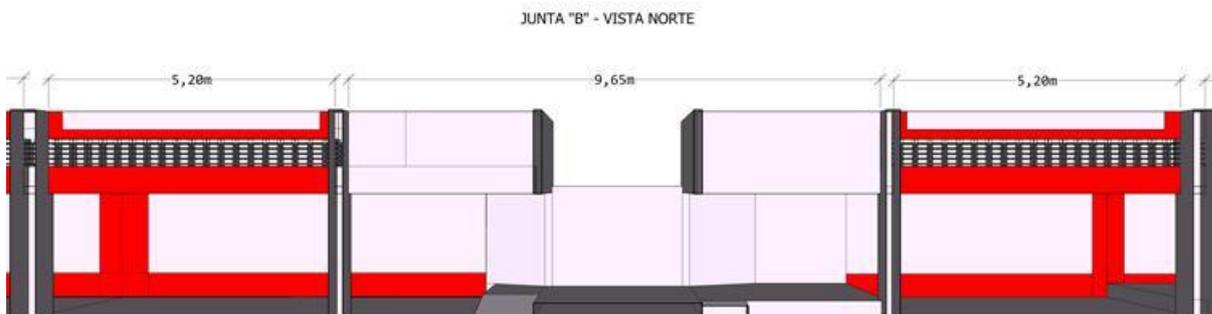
Vista Norte – Junta B com os pontos de reparação destacados em vermelho.
